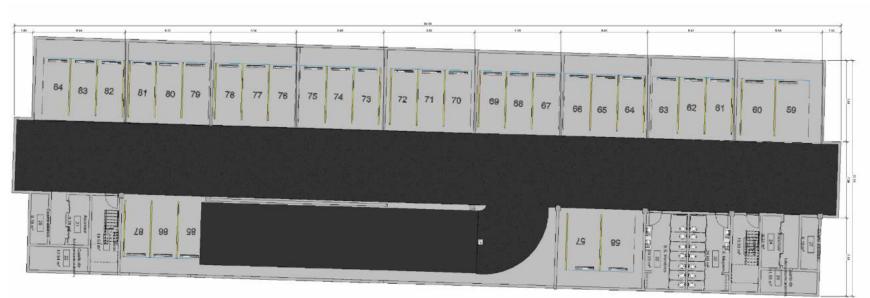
Planta tercer nivel subterráneo para propuesta arquitectónica de parqueo subterráneo.
